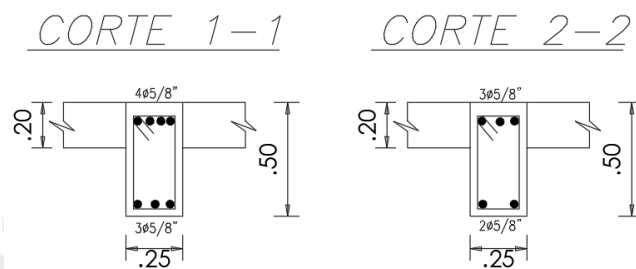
Corte 1-1 y Corte 2-2 en Viga V-6 (0.25x0.50m)
